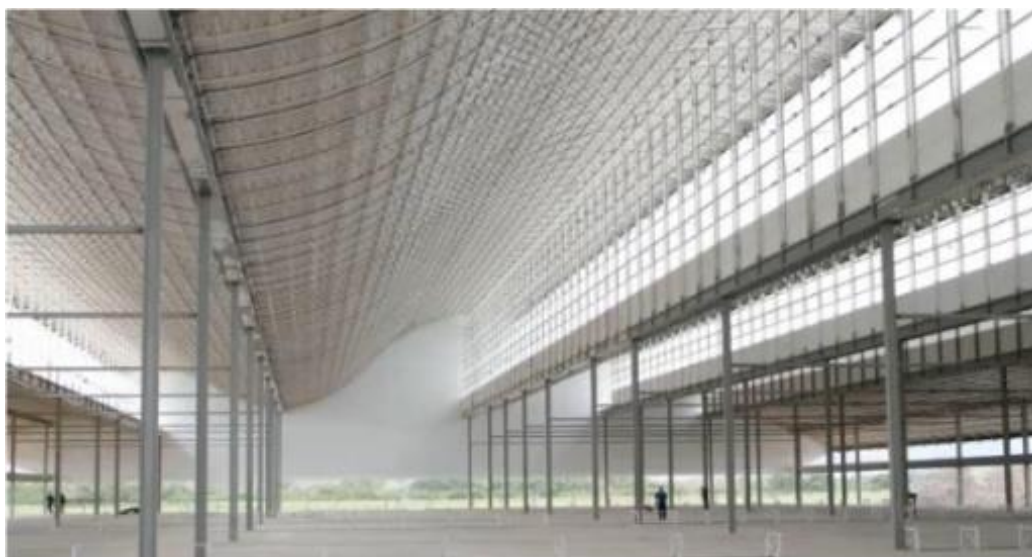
Modulação estrutural – Fonte: Museu da casa Brasileira. Disponível em: <www.mcb.sp.gov.br>
